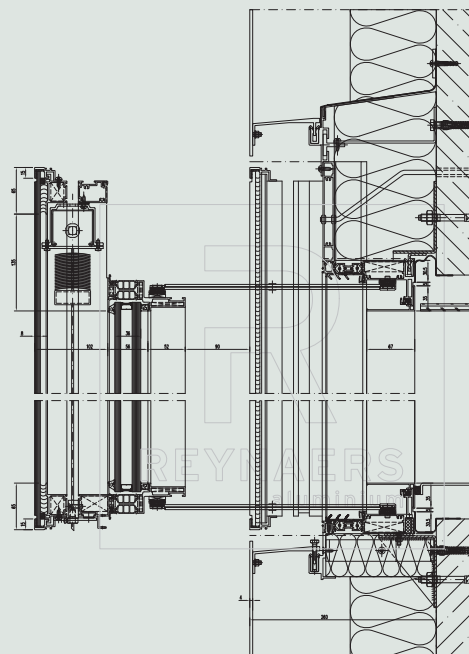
Vertikal-Schnitt Parallel-Ausstellfenster geöffnet
